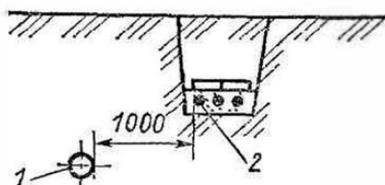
Прокладка кабелей параллельно трубопроводам, водопроводам, канализации, дренажу, газопроводам низкого и среднего давления:
